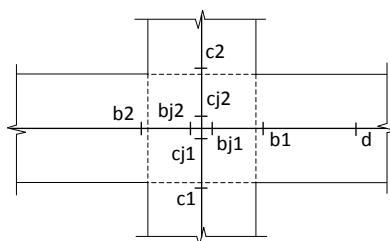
Identificação das secções transversais das vigas e pilares.
